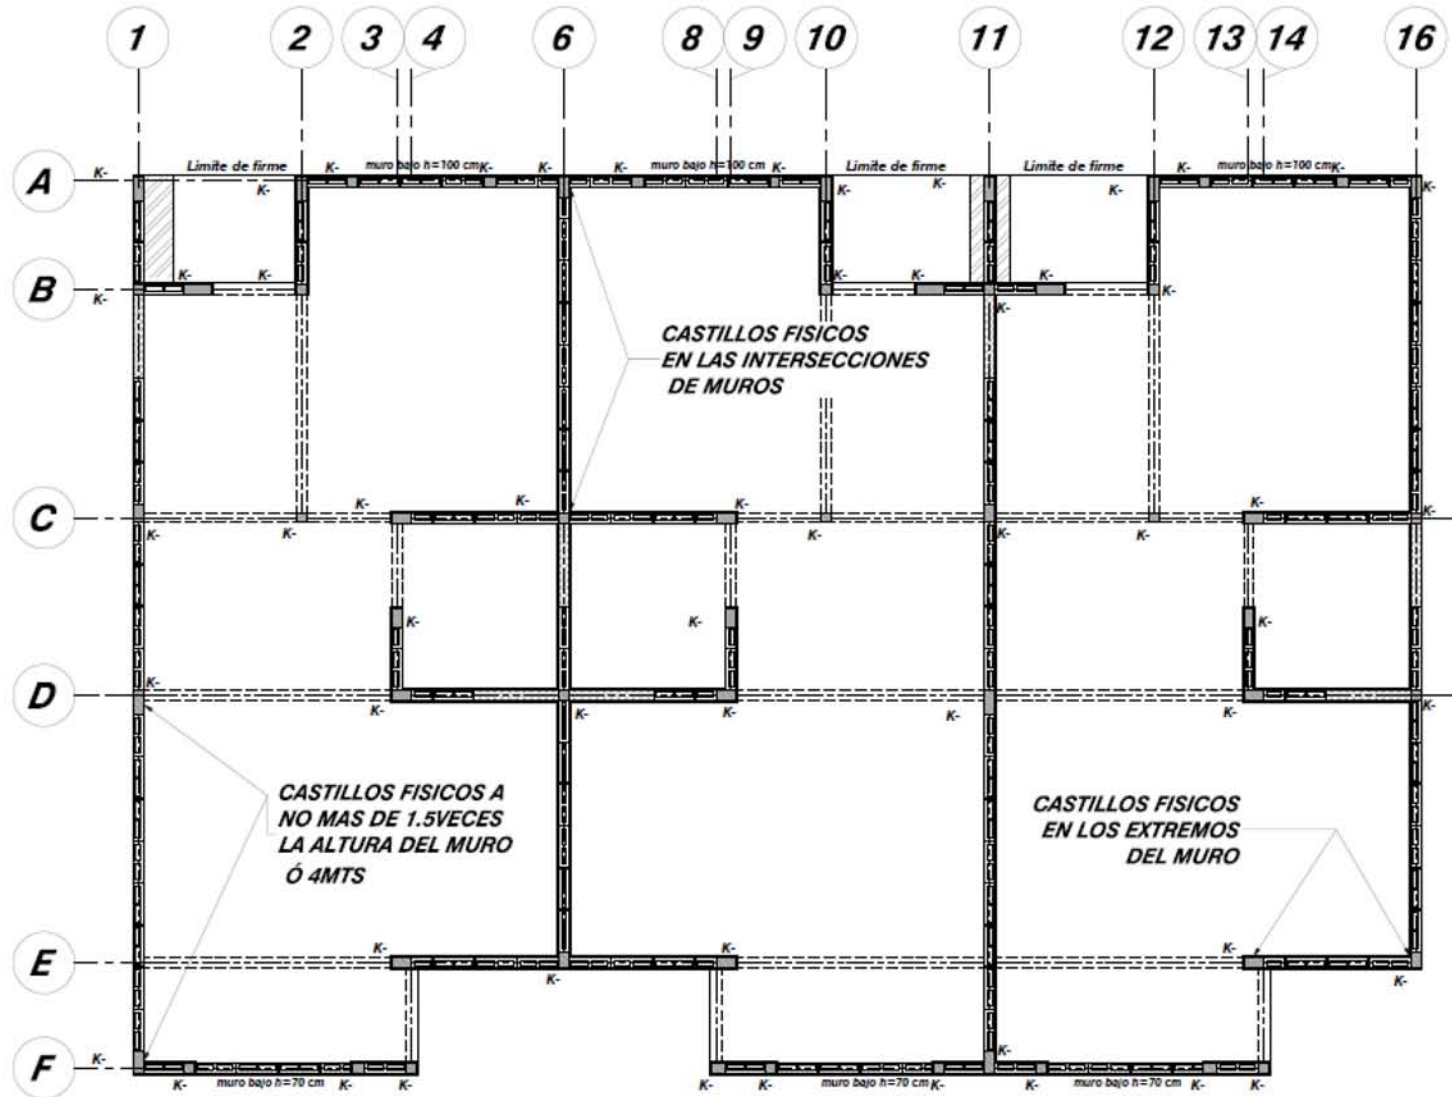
Planta tipo de una vivienda a base de mampostería confinada.
